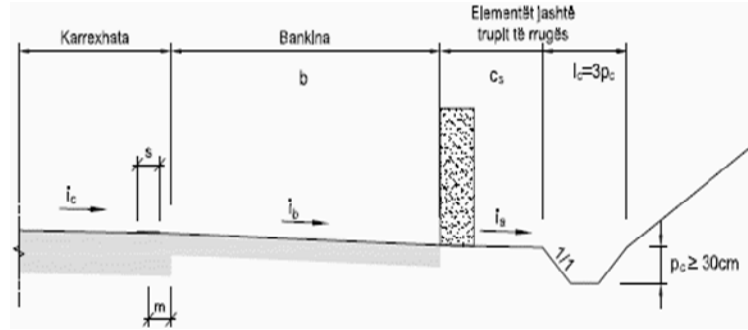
raste të ndryshme të dimensioneve të bankinës së paveshur
